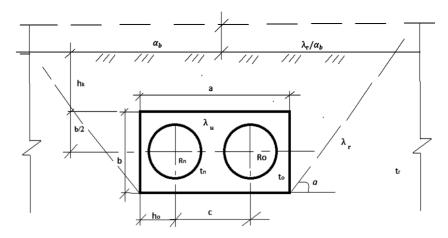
Расчетная схема оптимизации параметров бесканальной прокладки подземной теплоизолированной теплосети
